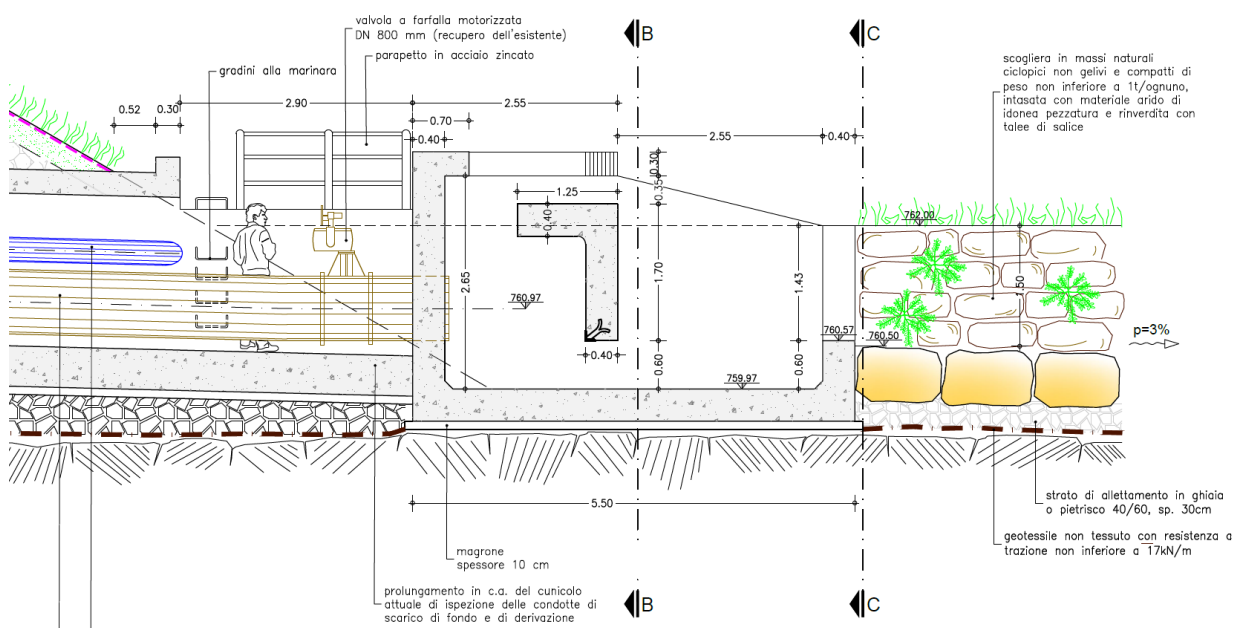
Stato di progetto: sezione maestra e prospetto del paramento di monte
